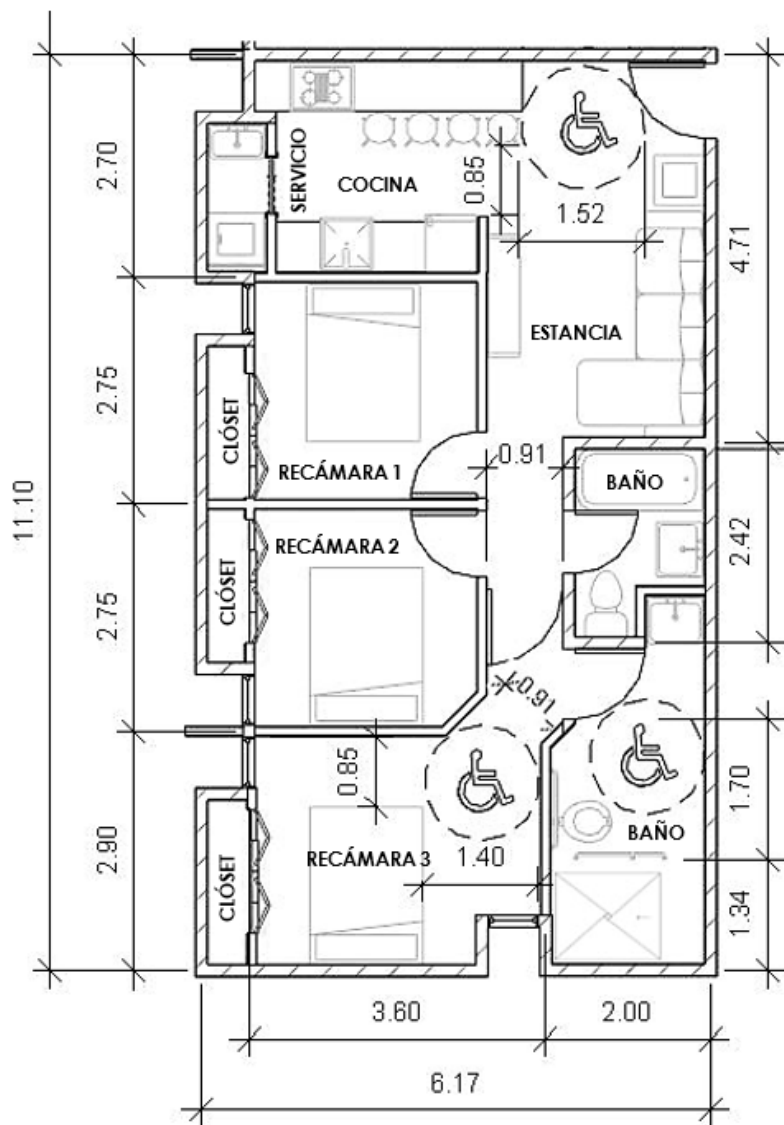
Planta arquitectónica de Vivienda tipo “A”
